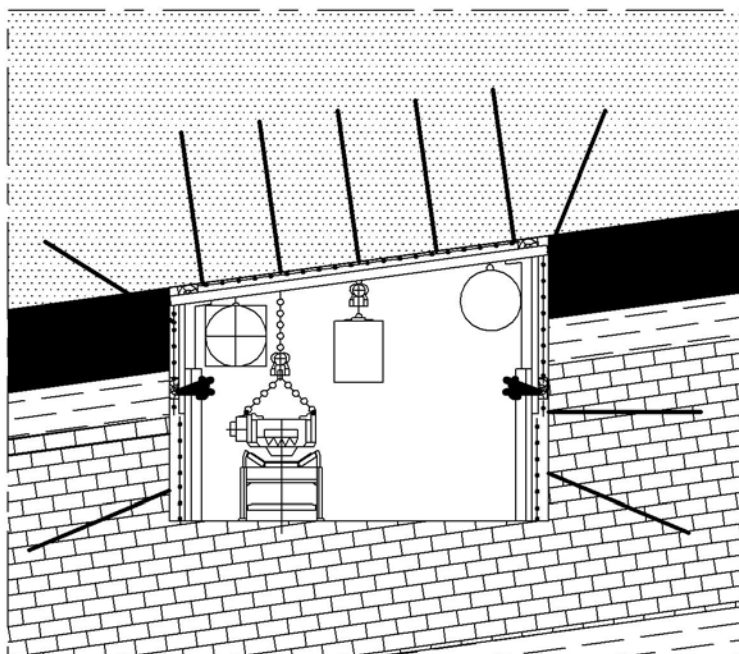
Поперечное сечение штрека пласта m_3 в проходке.
